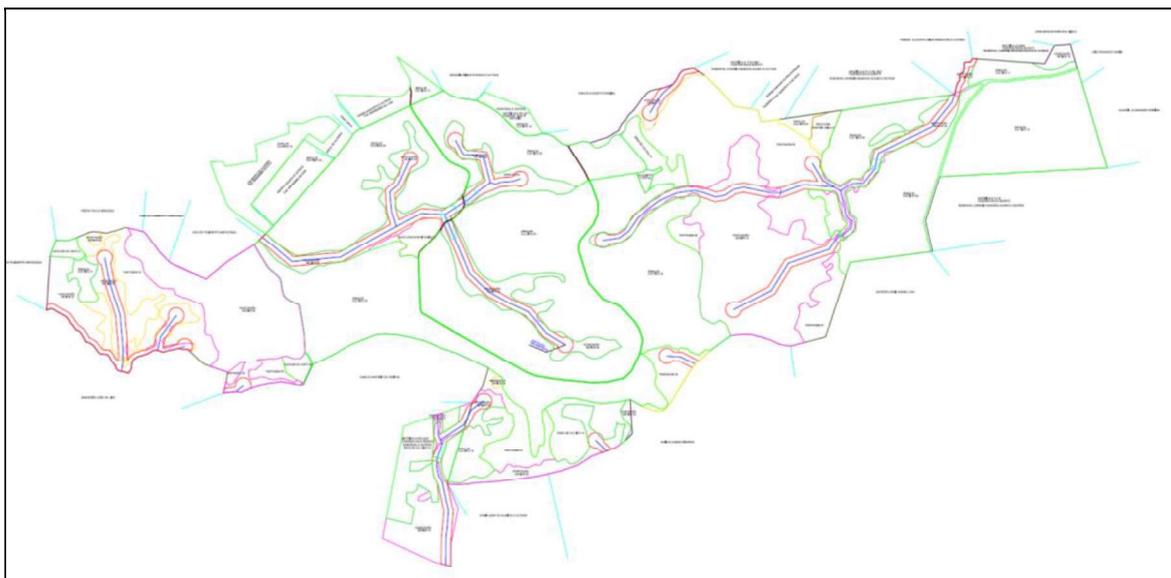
Planta de uso e ocupação do empreendimento. Fonte: SLA.
